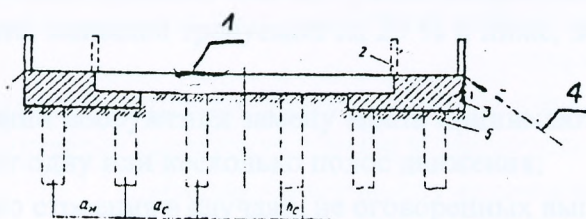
Схема уширения с объединением по сваям: 1 – существующая насадка; 2 – удаляемый открьлок; 3 – монолитная конструкция уширения; 4 – насыпь; 5 – сваи.
